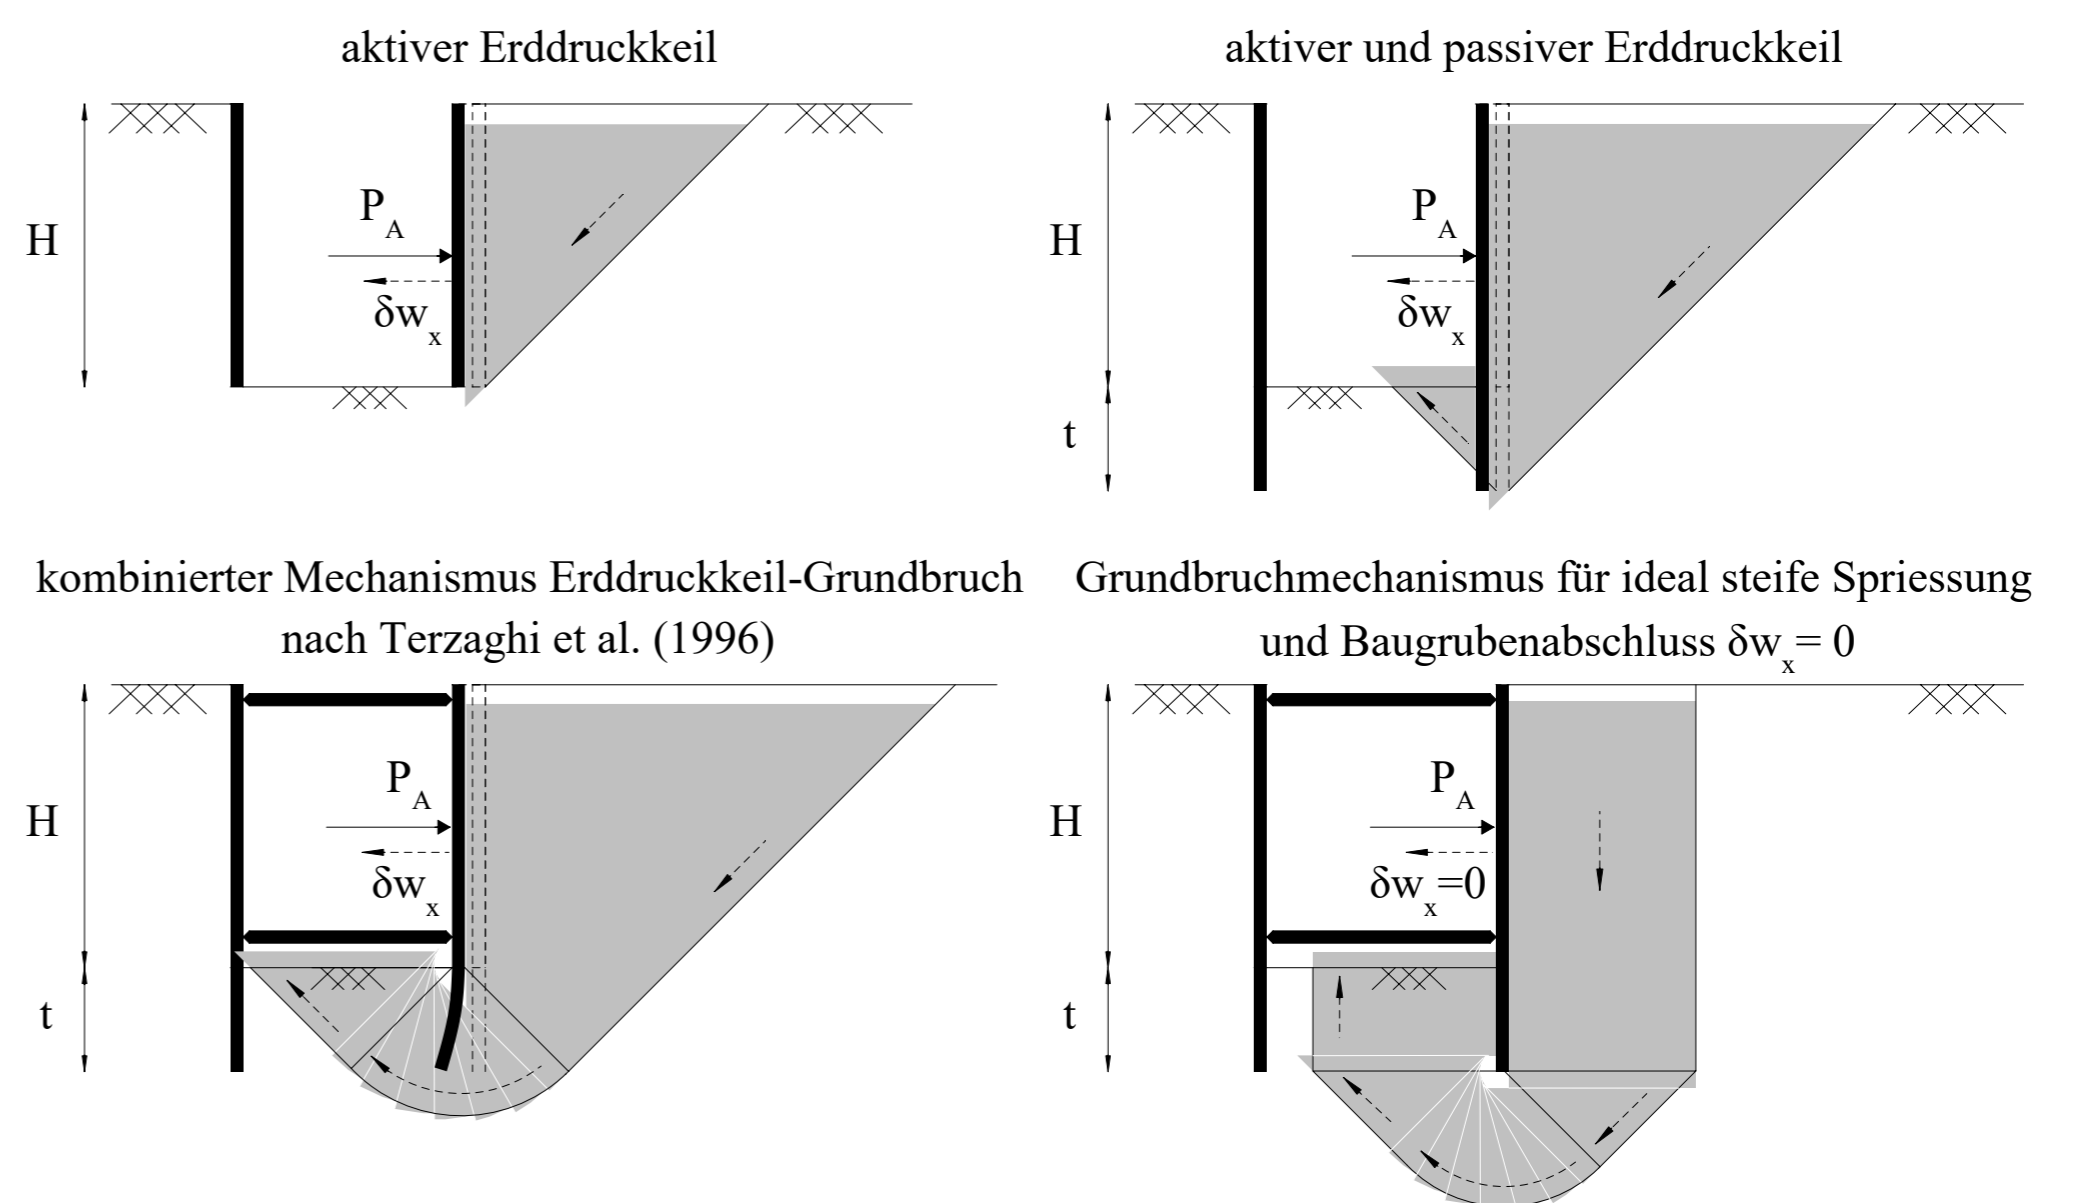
Vergleich verschiedener Bruchmechanismen für Baugruben in weichen Böden mit einer statischen Grundbruchgefährdung.
